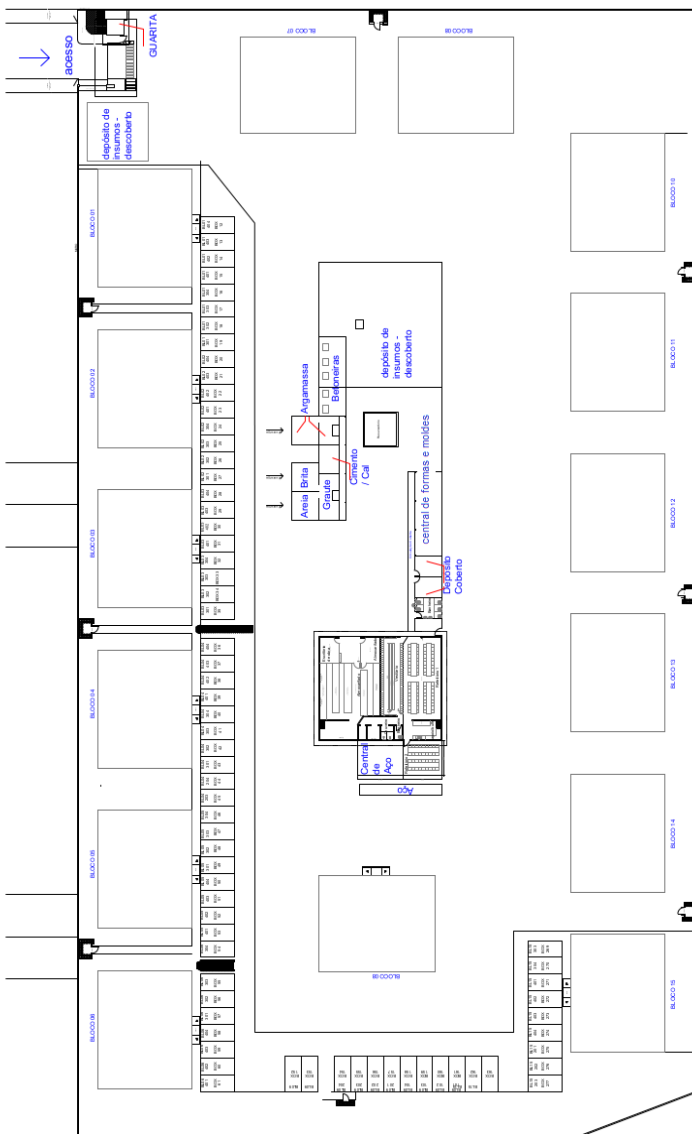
Arranjo físico da área de produção do canteiro de obras.
